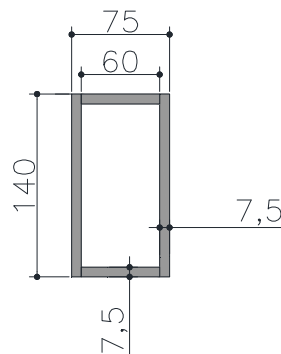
Dimensões do perfil utilizado como dente metálico.
